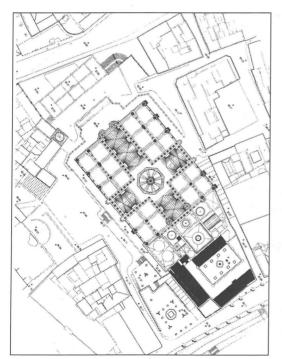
Catedral de Jerez. Plano de Situación (Diáñez)
